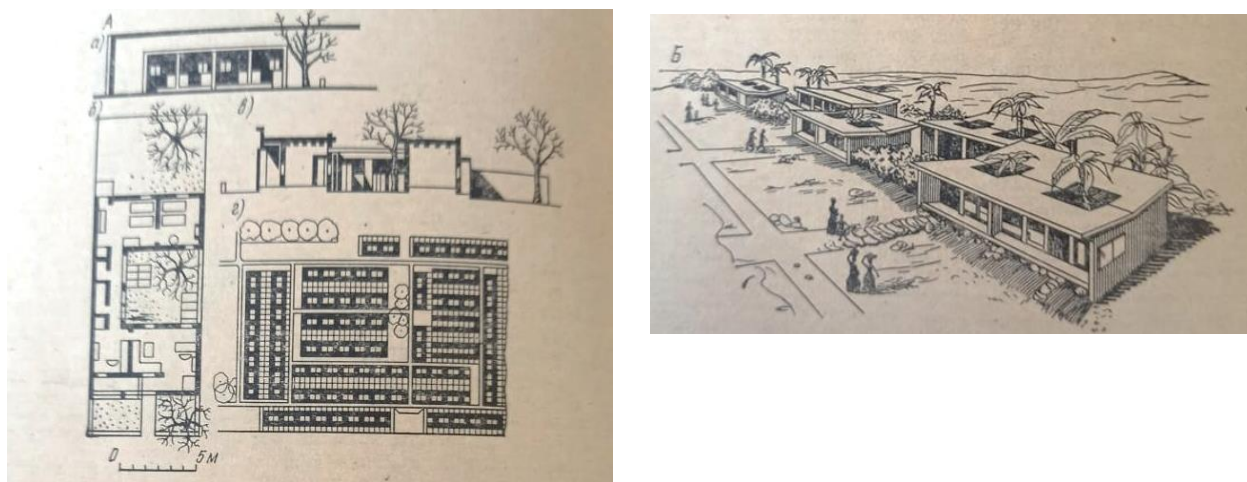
Малоэтажные дома с внутренними двориками: А – поселок для сельскохозяйственных рабочих в Чандигархе (Индия, арх. Жаннере); а – фрагмент фасада; б – план
